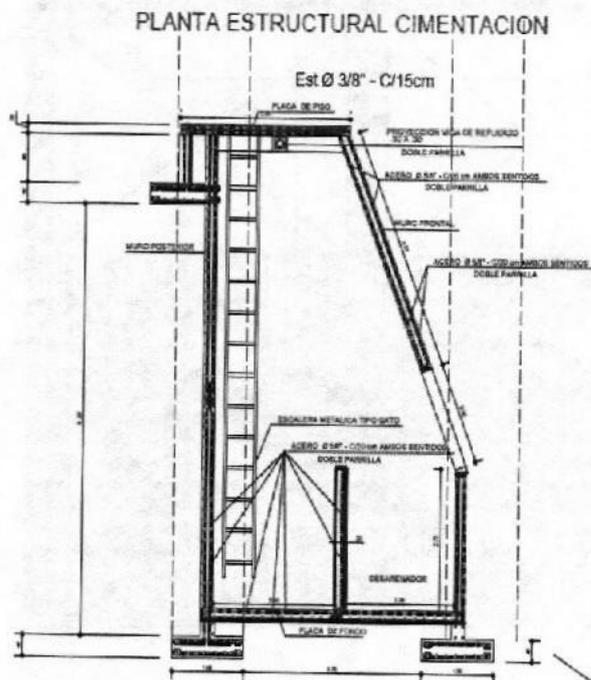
Planta estructural cimentación EB río Tukurinca. Fuente: Plano estructural solicitante
